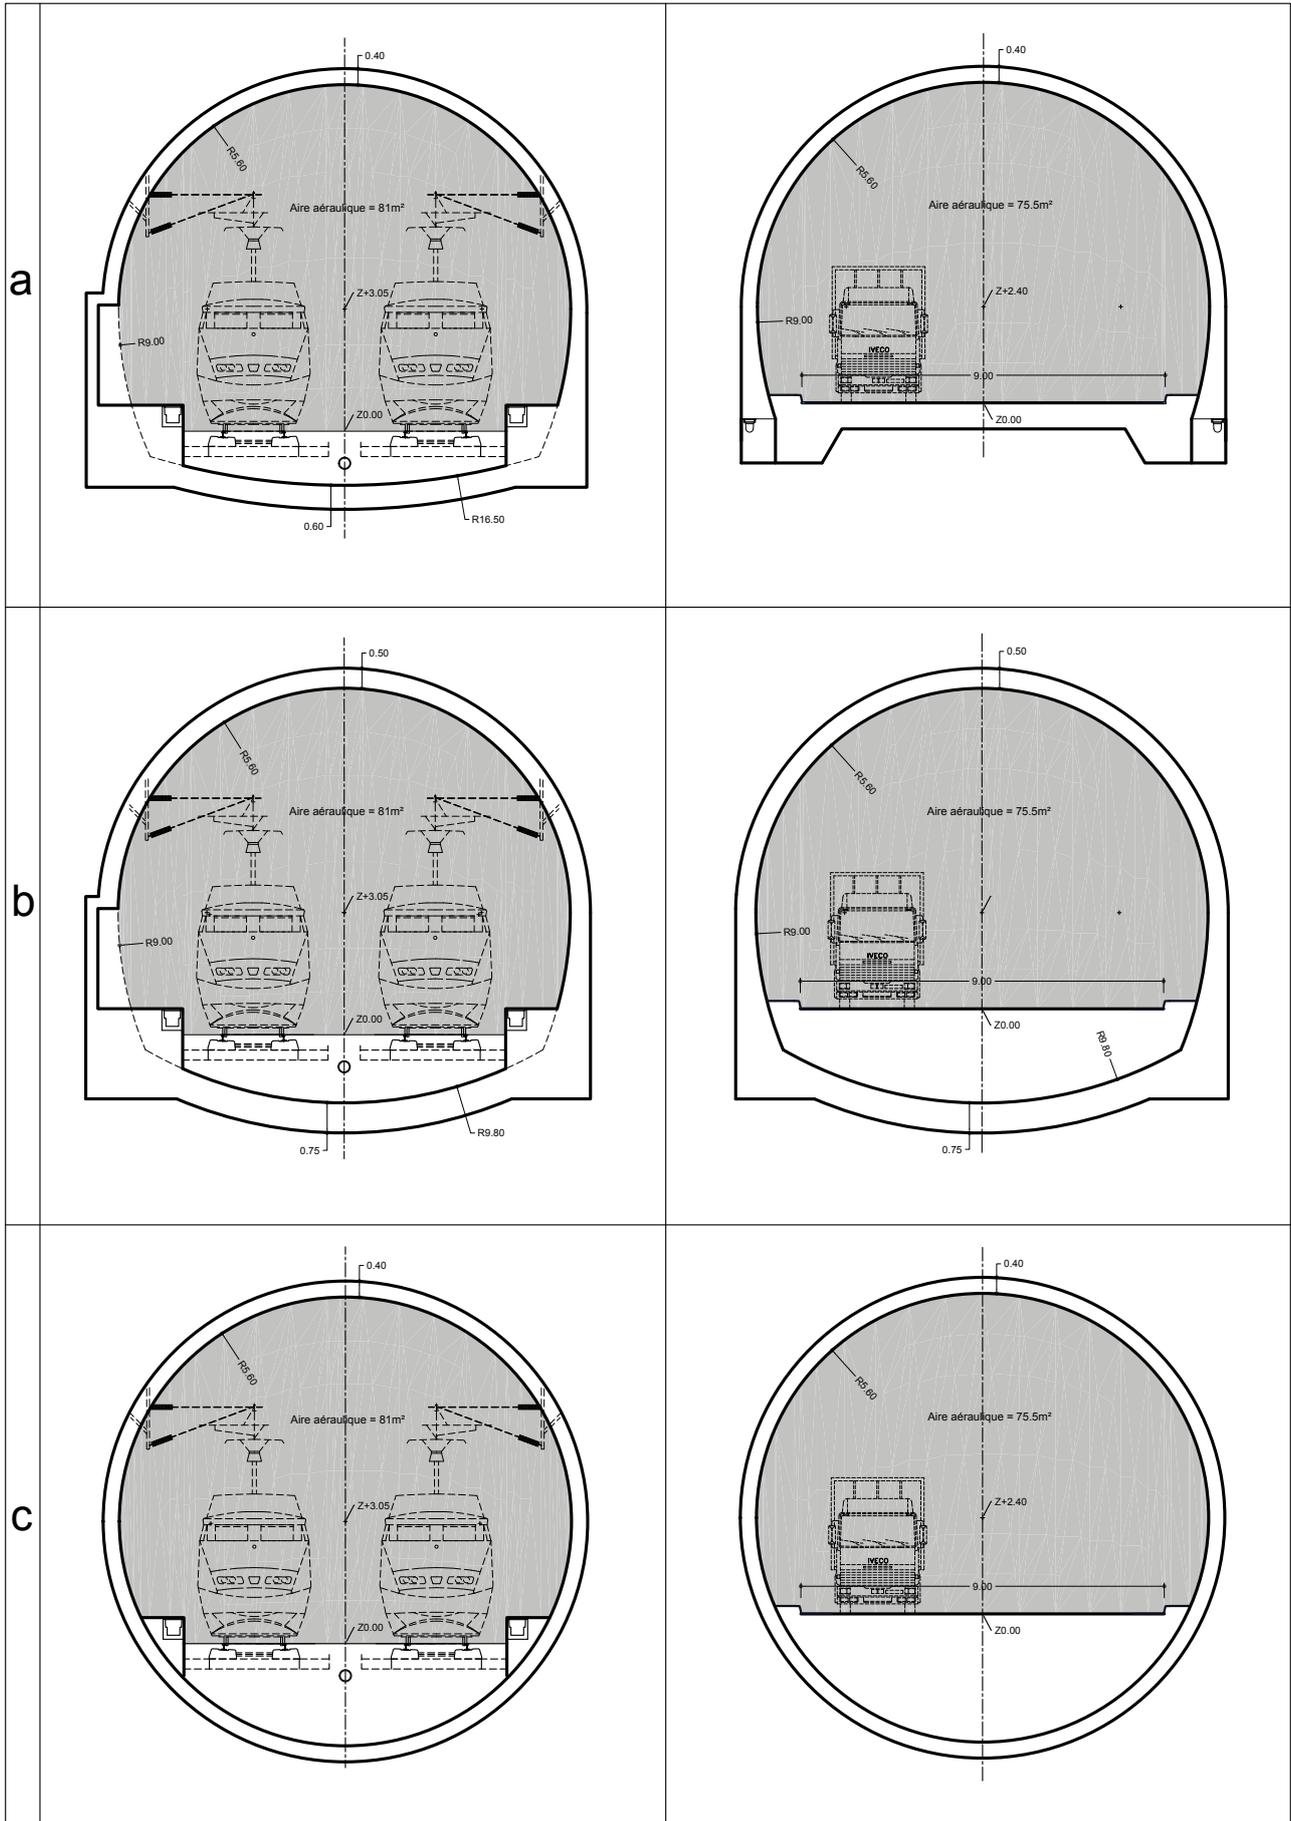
Sections transversales pour la géométrie D11 (à gauche : tunnels ferroviaires, à droite : tunnels routiers)
